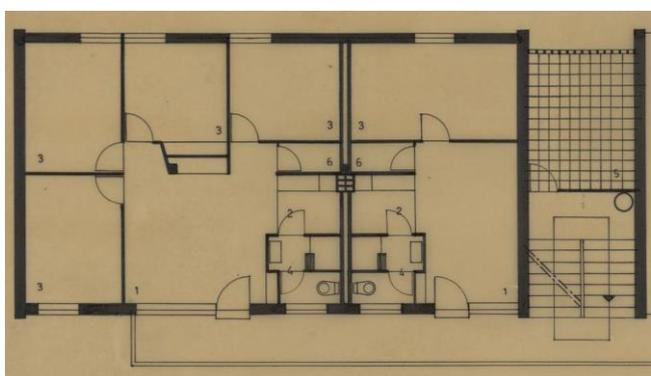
Planta de um T4 e de um T1 no bloco G do bairro do Amial.
